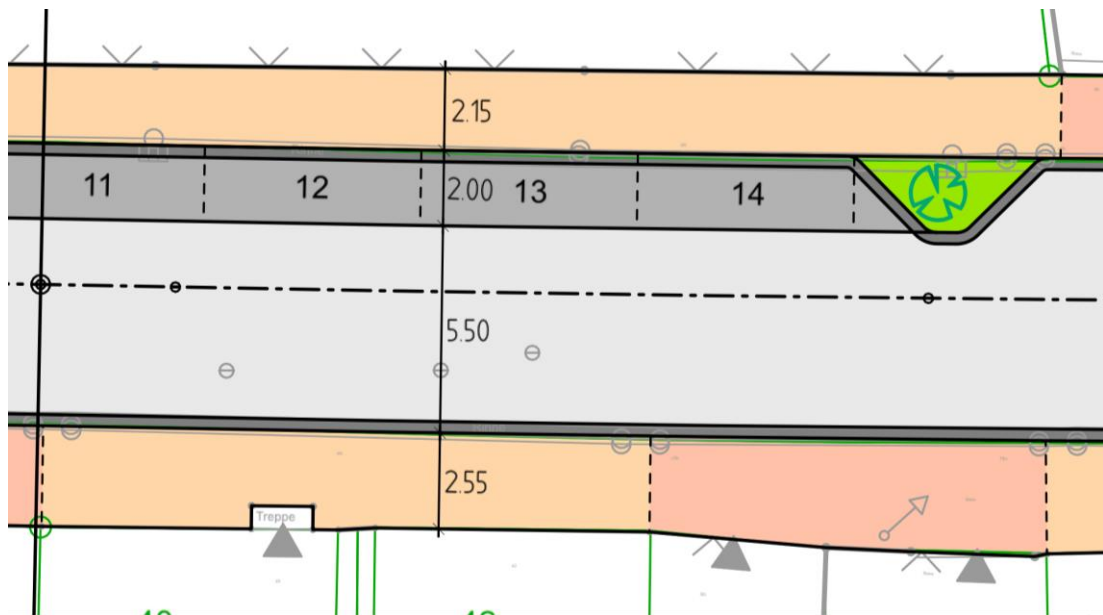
Planausschnitt Variante 1 abgelehnte Parkplatzgestaltung aus verkehrlicher und betrieblicher Sicht von Hessen Mobil
